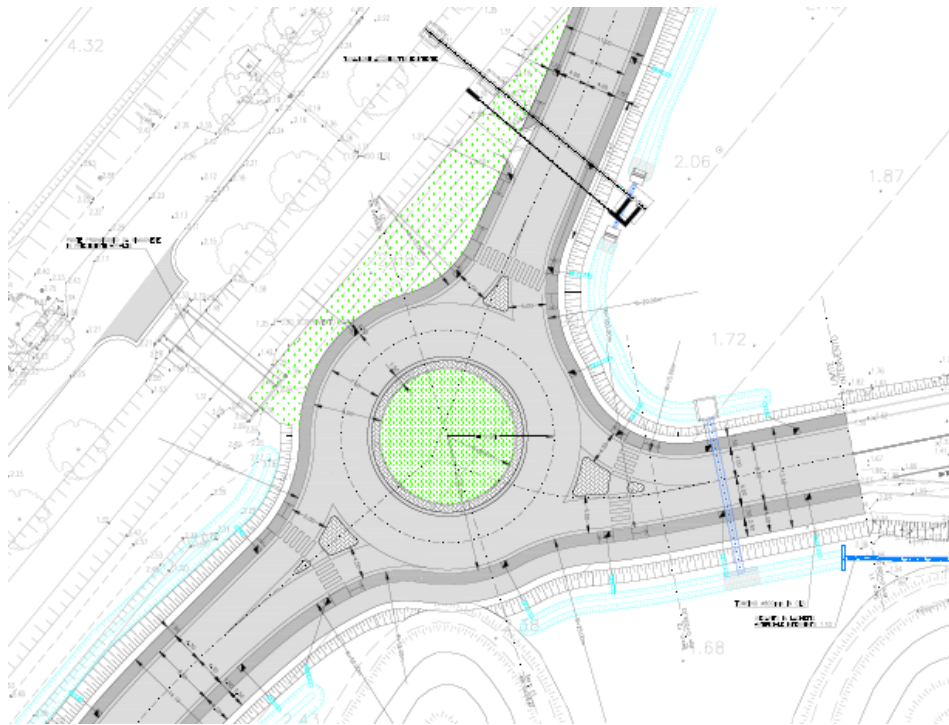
Stralcio planimetrico rotatoria di via Olimpia
